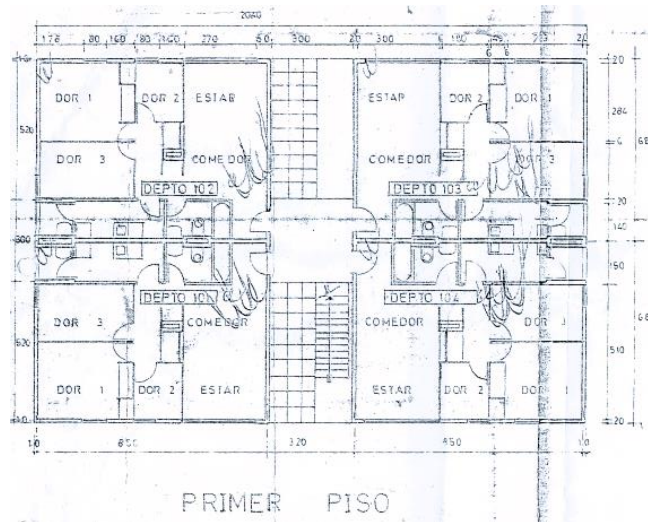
Vista en planta, primer piso del edificio de HA.
